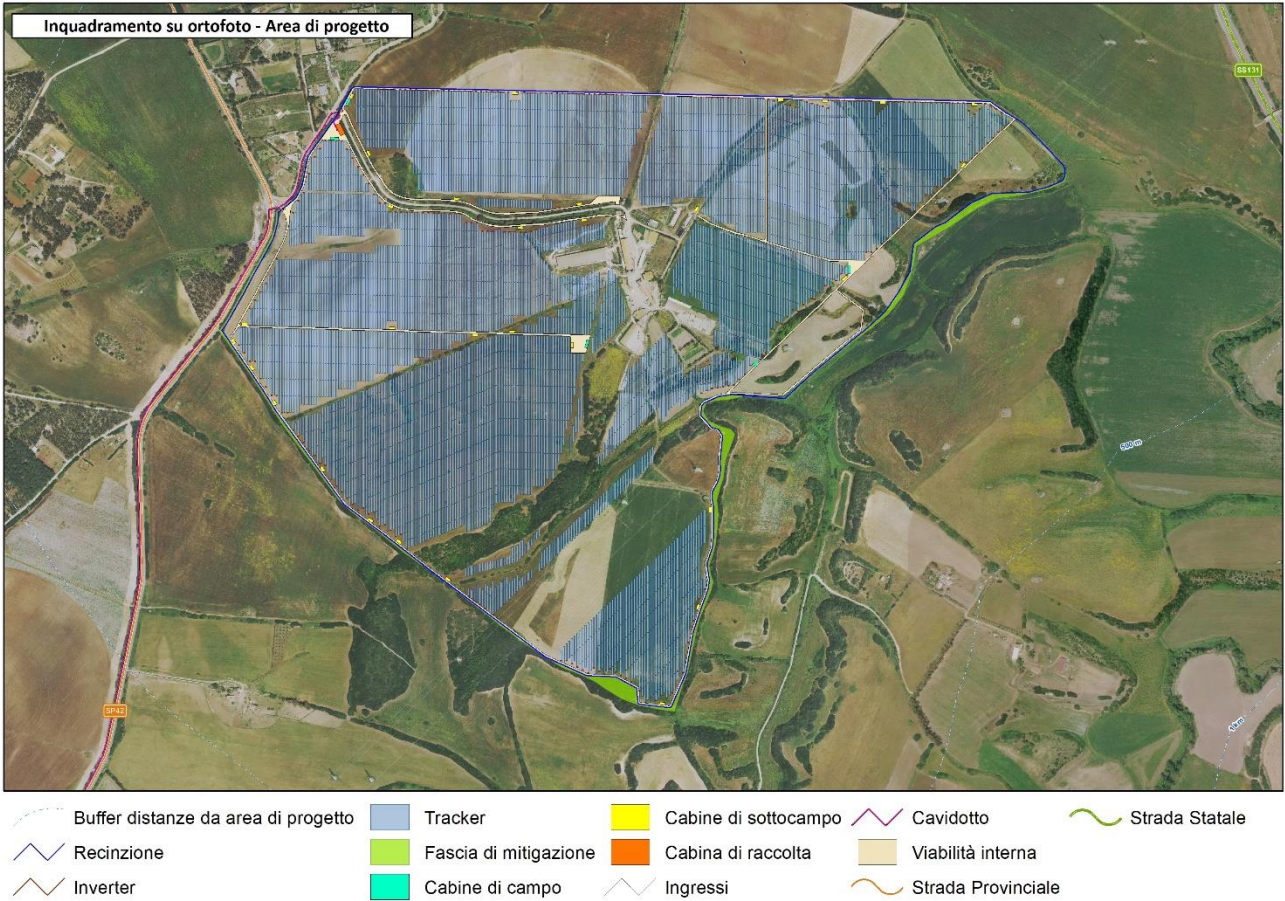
inquadramento su ortofoto- vista di dettaglio.
